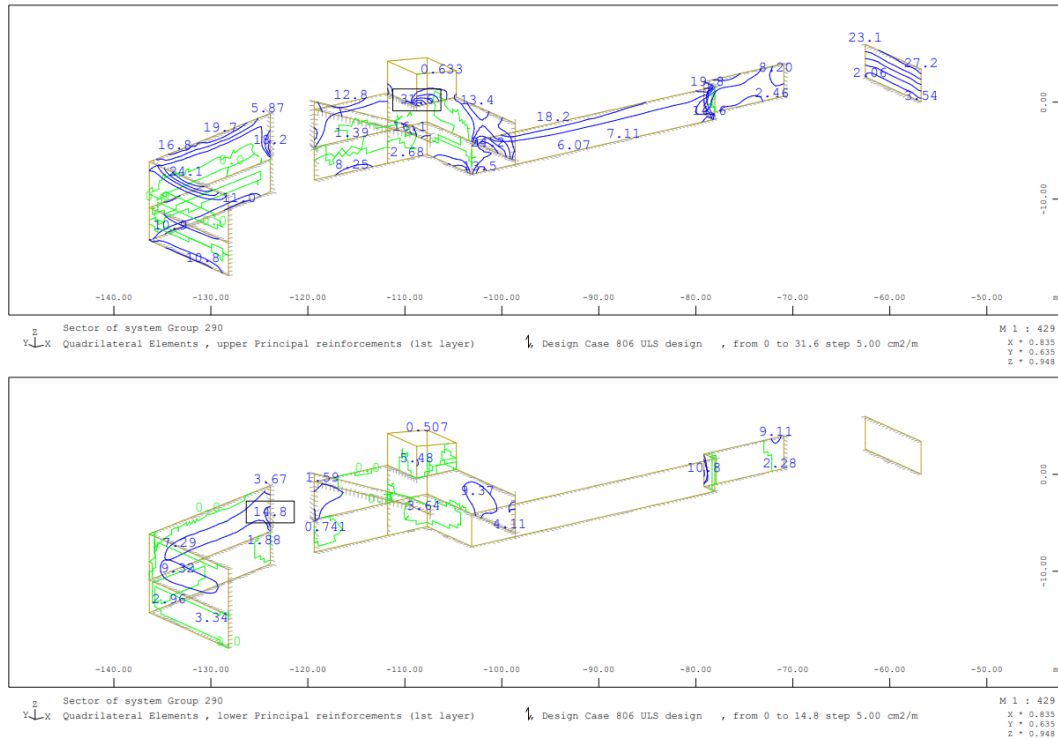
Armadura vertical na face exterior (sup.) e interior (inf.) – muros – acesso Norte - ELU
